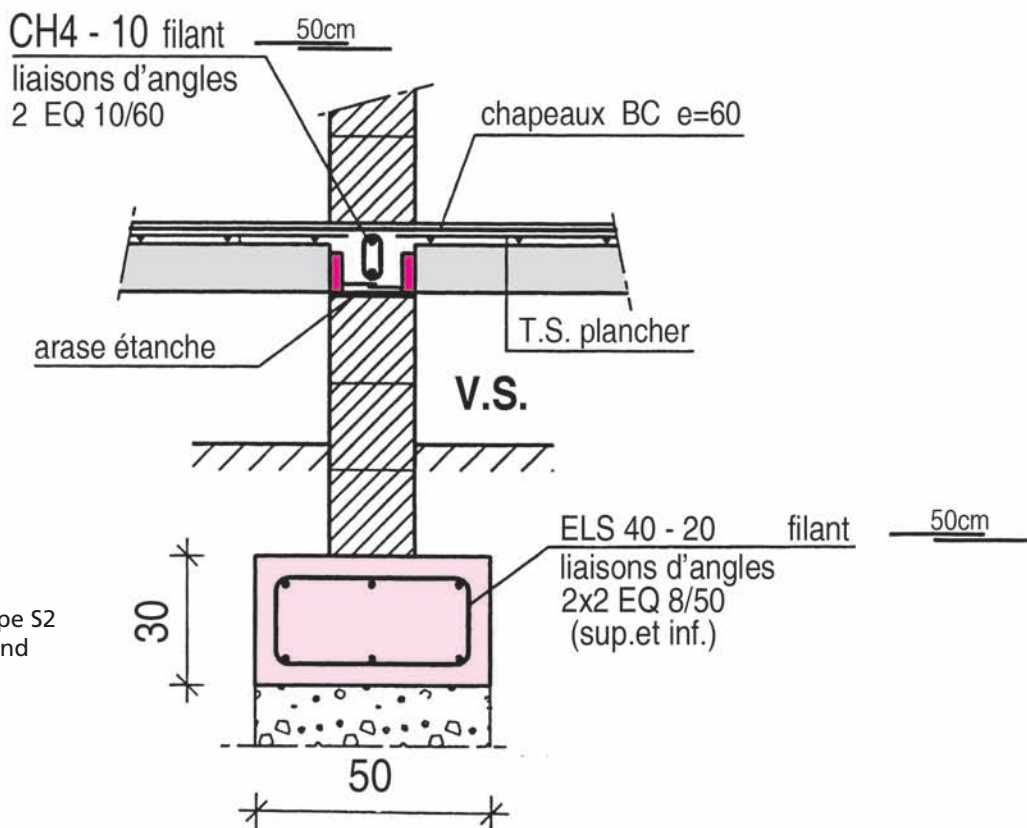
Semelle filante de type S2 sous les murs de refend
